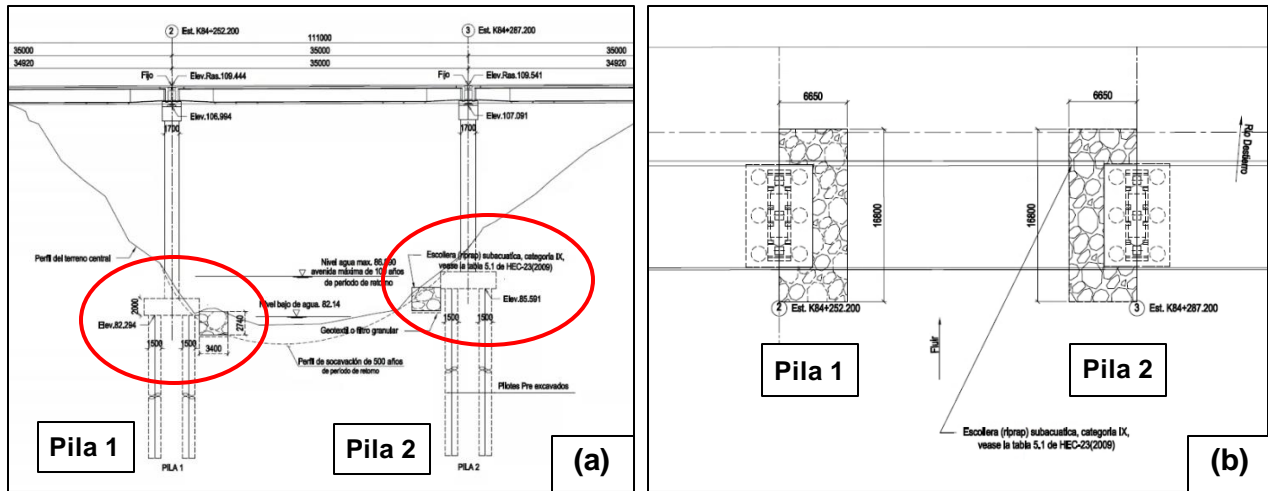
Detalle de las escolleras para prevención de socavación de las cimentaciones de las pilas del puente nuevo sobre el río Destierro. (a) Vista en elevación. (b) Vista en planta.
